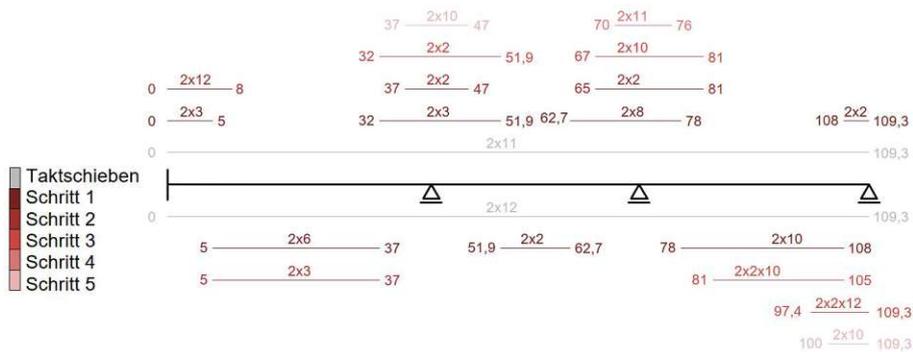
Vorspannung Betonagevariante C aus [1]
